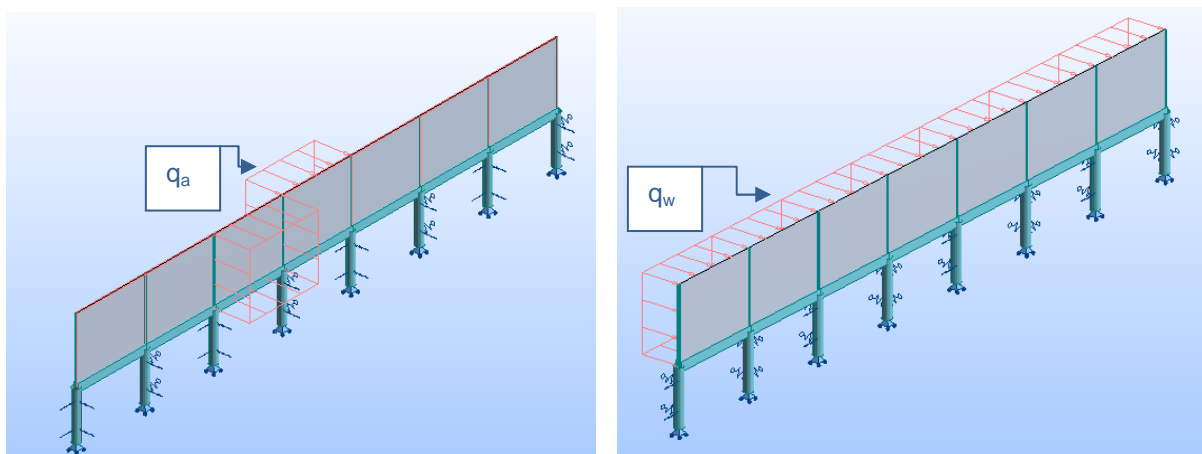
Cargas Horizontais Aplicadas à Barreira
